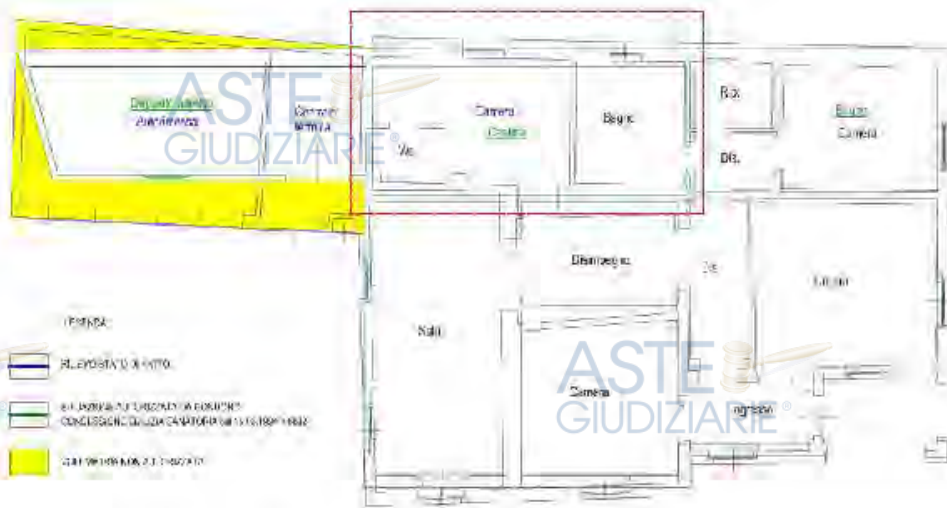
Planimetria di confronto tra rilievo stato di fatto e situazione autorizzata con evidenziazione in giallo della volumetria aggiuntiva e con riquadro rosso dei locali oggetto di cambio di destinazione d'uso da cantina a camera e bagno
